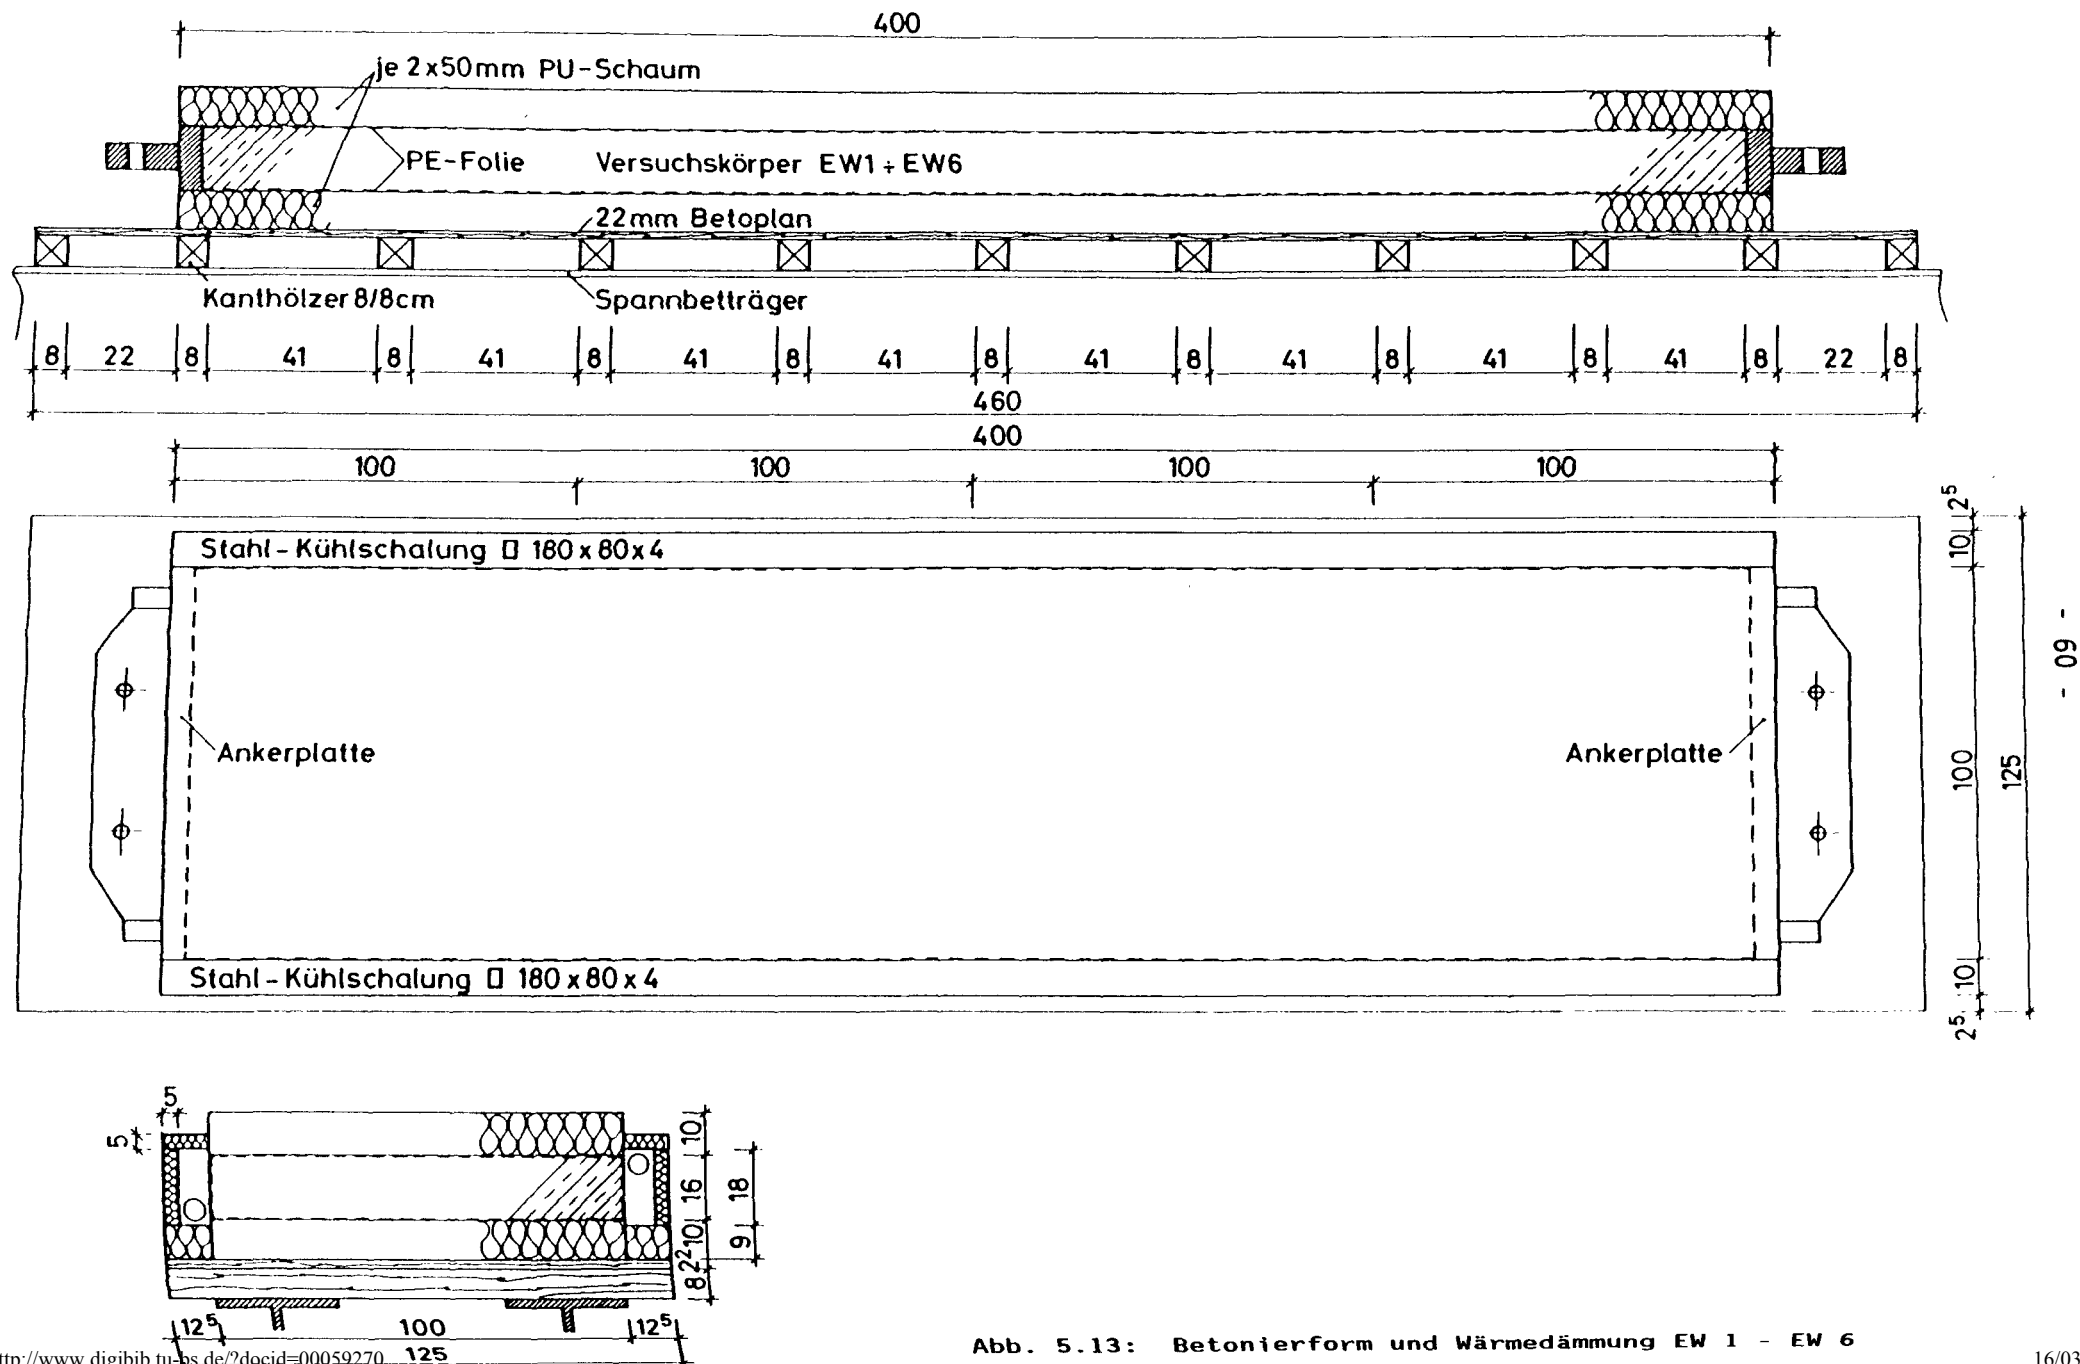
Betonierform und Wärmedämmung EW 1 - EW 6
